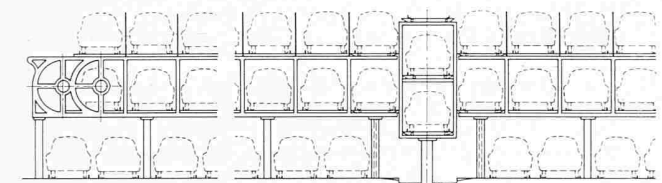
Konstruktionstyp für einstöckigen Oberflurbau
